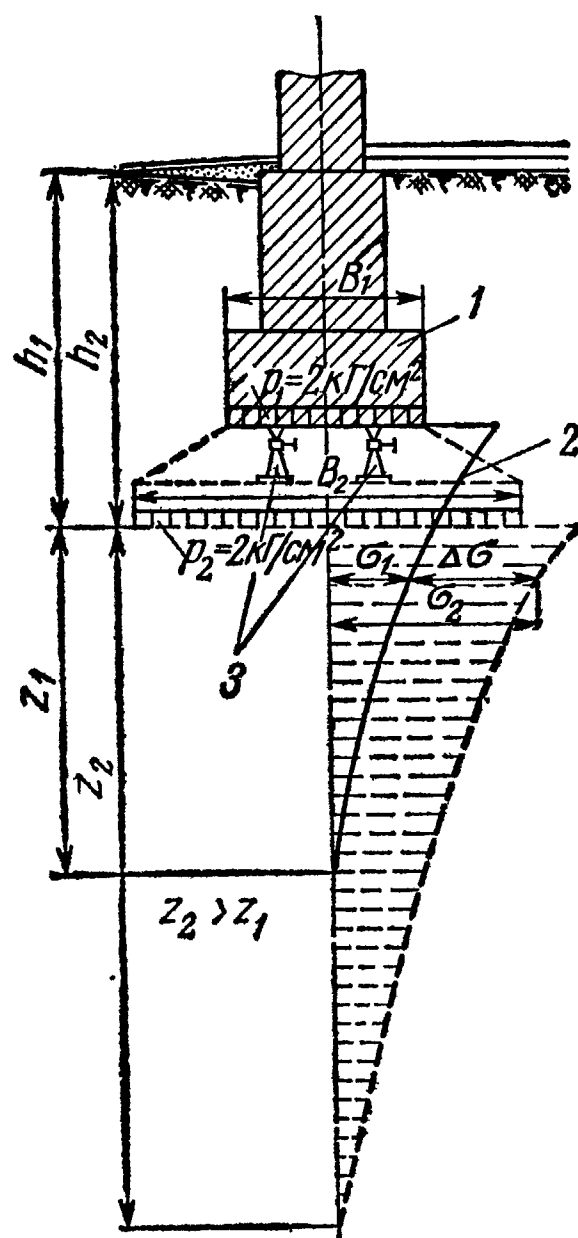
Схема предварительного обжатия фундаментов с помощью домкратов: 1 — фундамент до надстройки и уширения подошвы; 2 — фундамент после надстройки и уширения подошвы; 3 — домкраты
